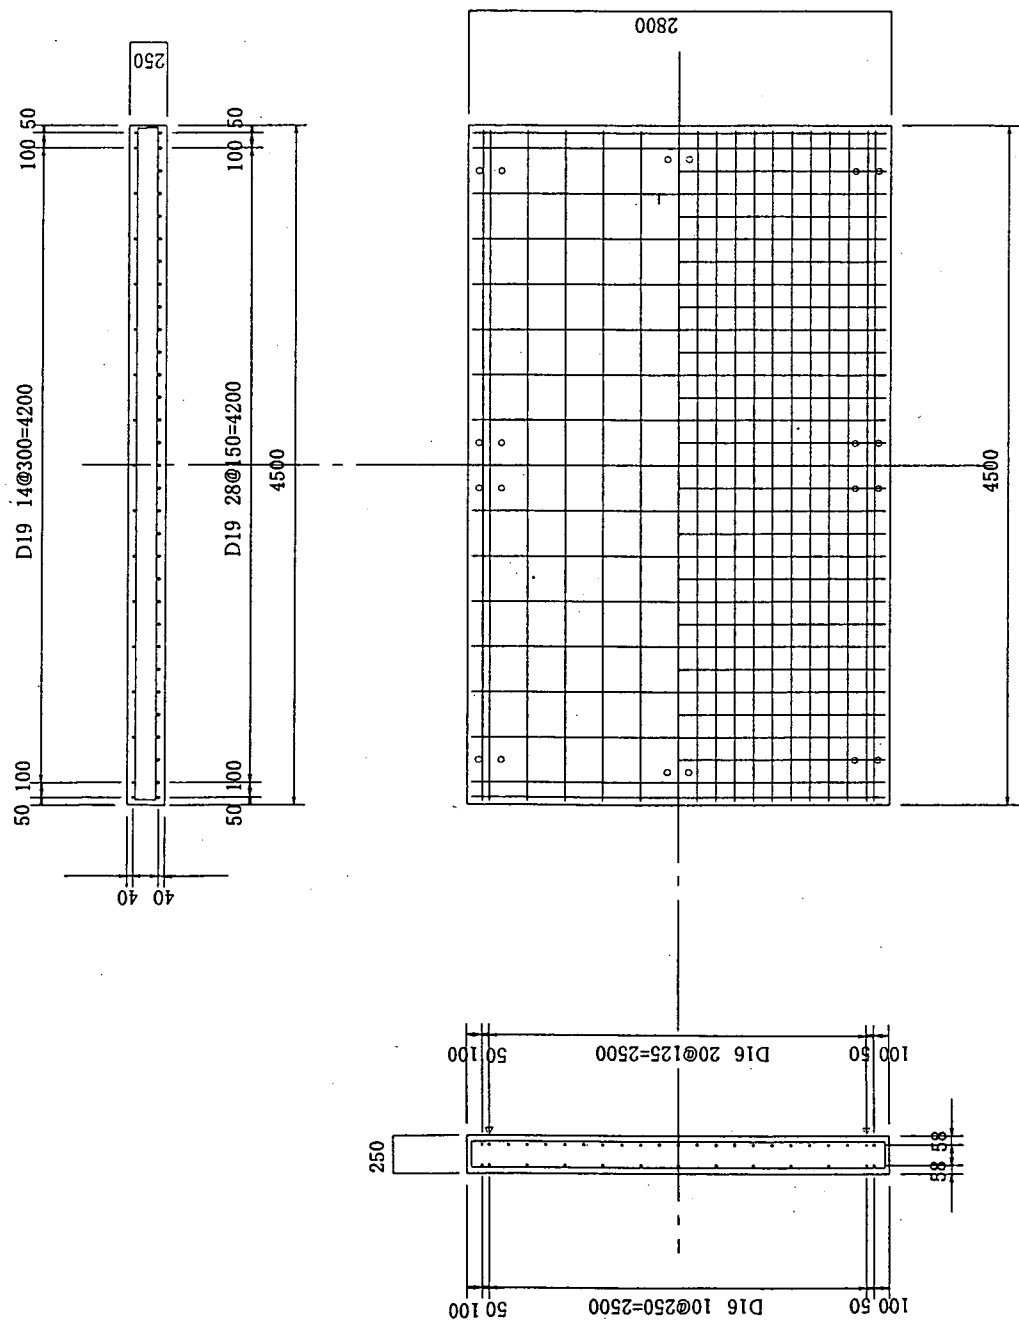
RC8n供試体の形状・寸法 (単位:mm)
